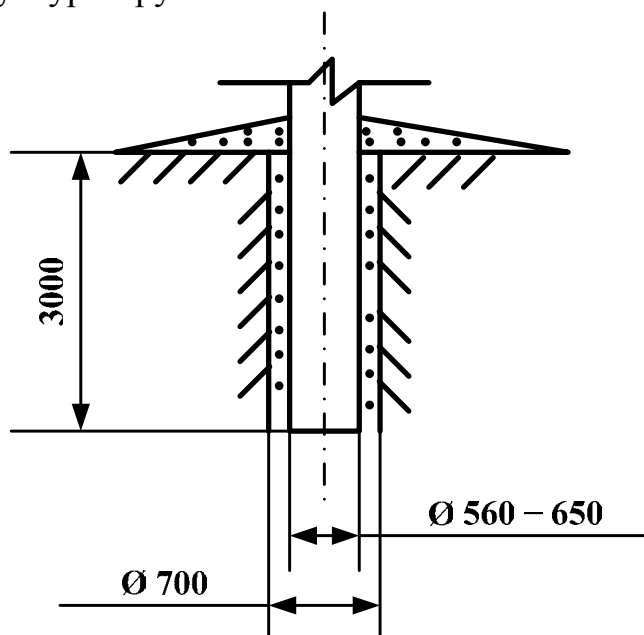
Закрепление стойки в ненарушенном грунте
